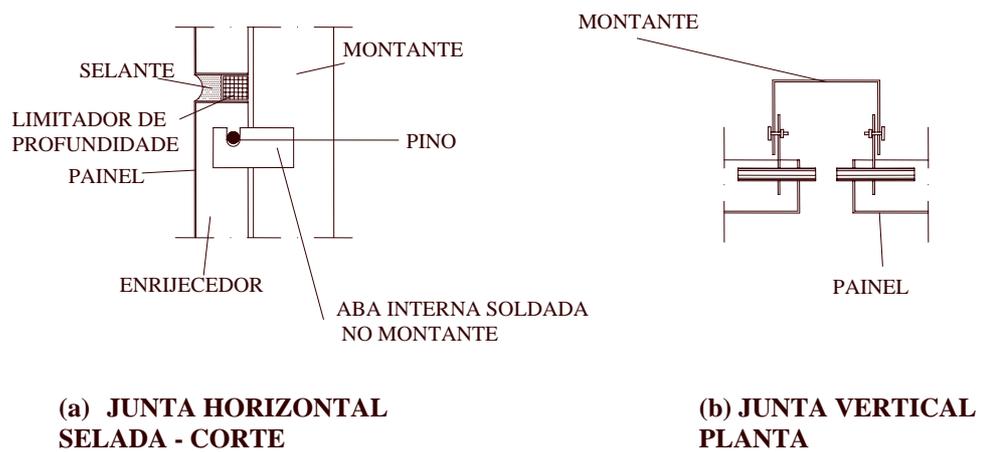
Detalhe da fixação do painel perfilado com encaixe de pino e junta selada.
